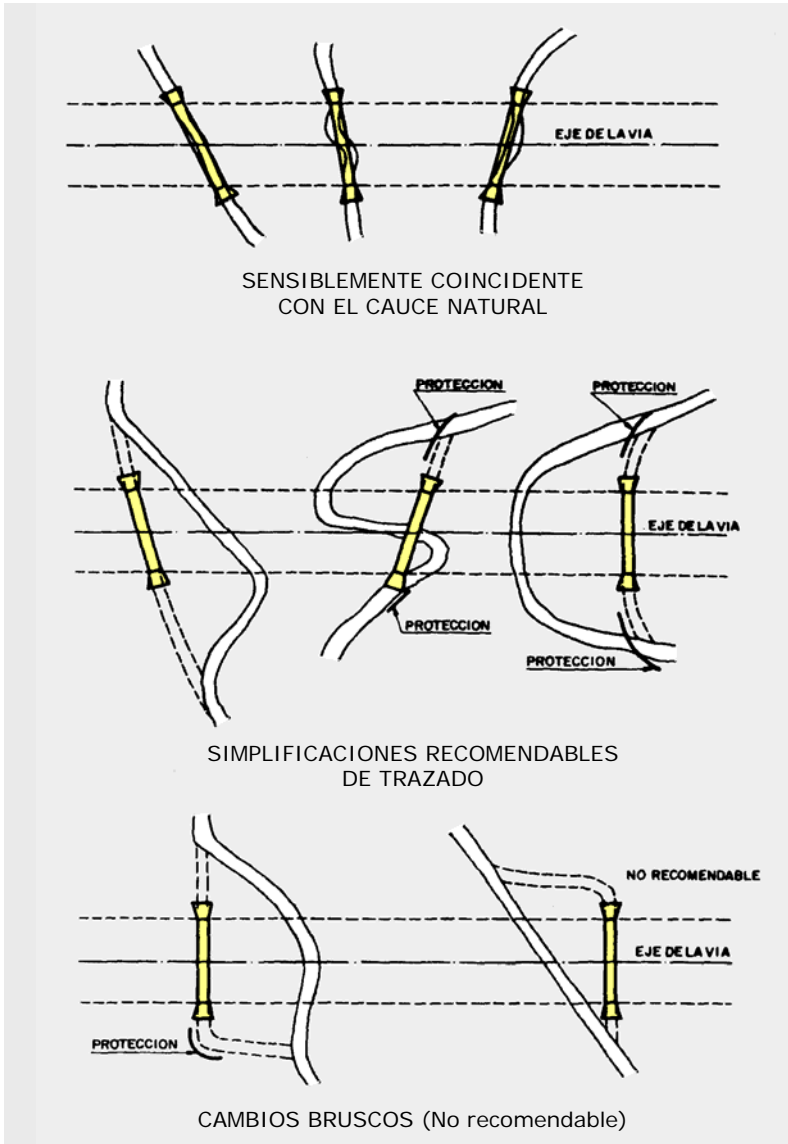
Plantas de pequeñas obras de drenaje transversal (5.2-1C)
